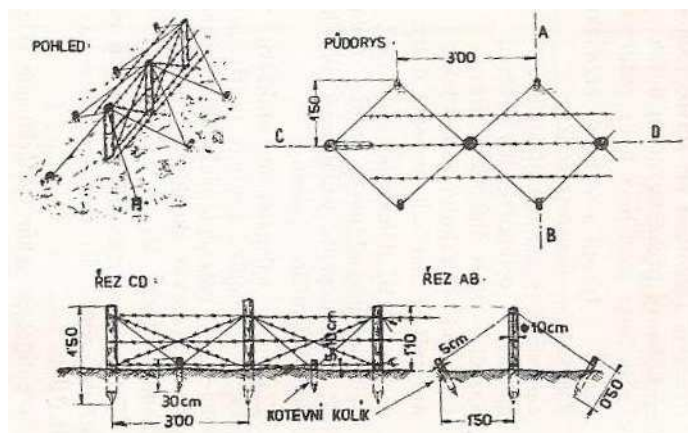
připevnění ostnatého drátu k dřevěným kolíkům
